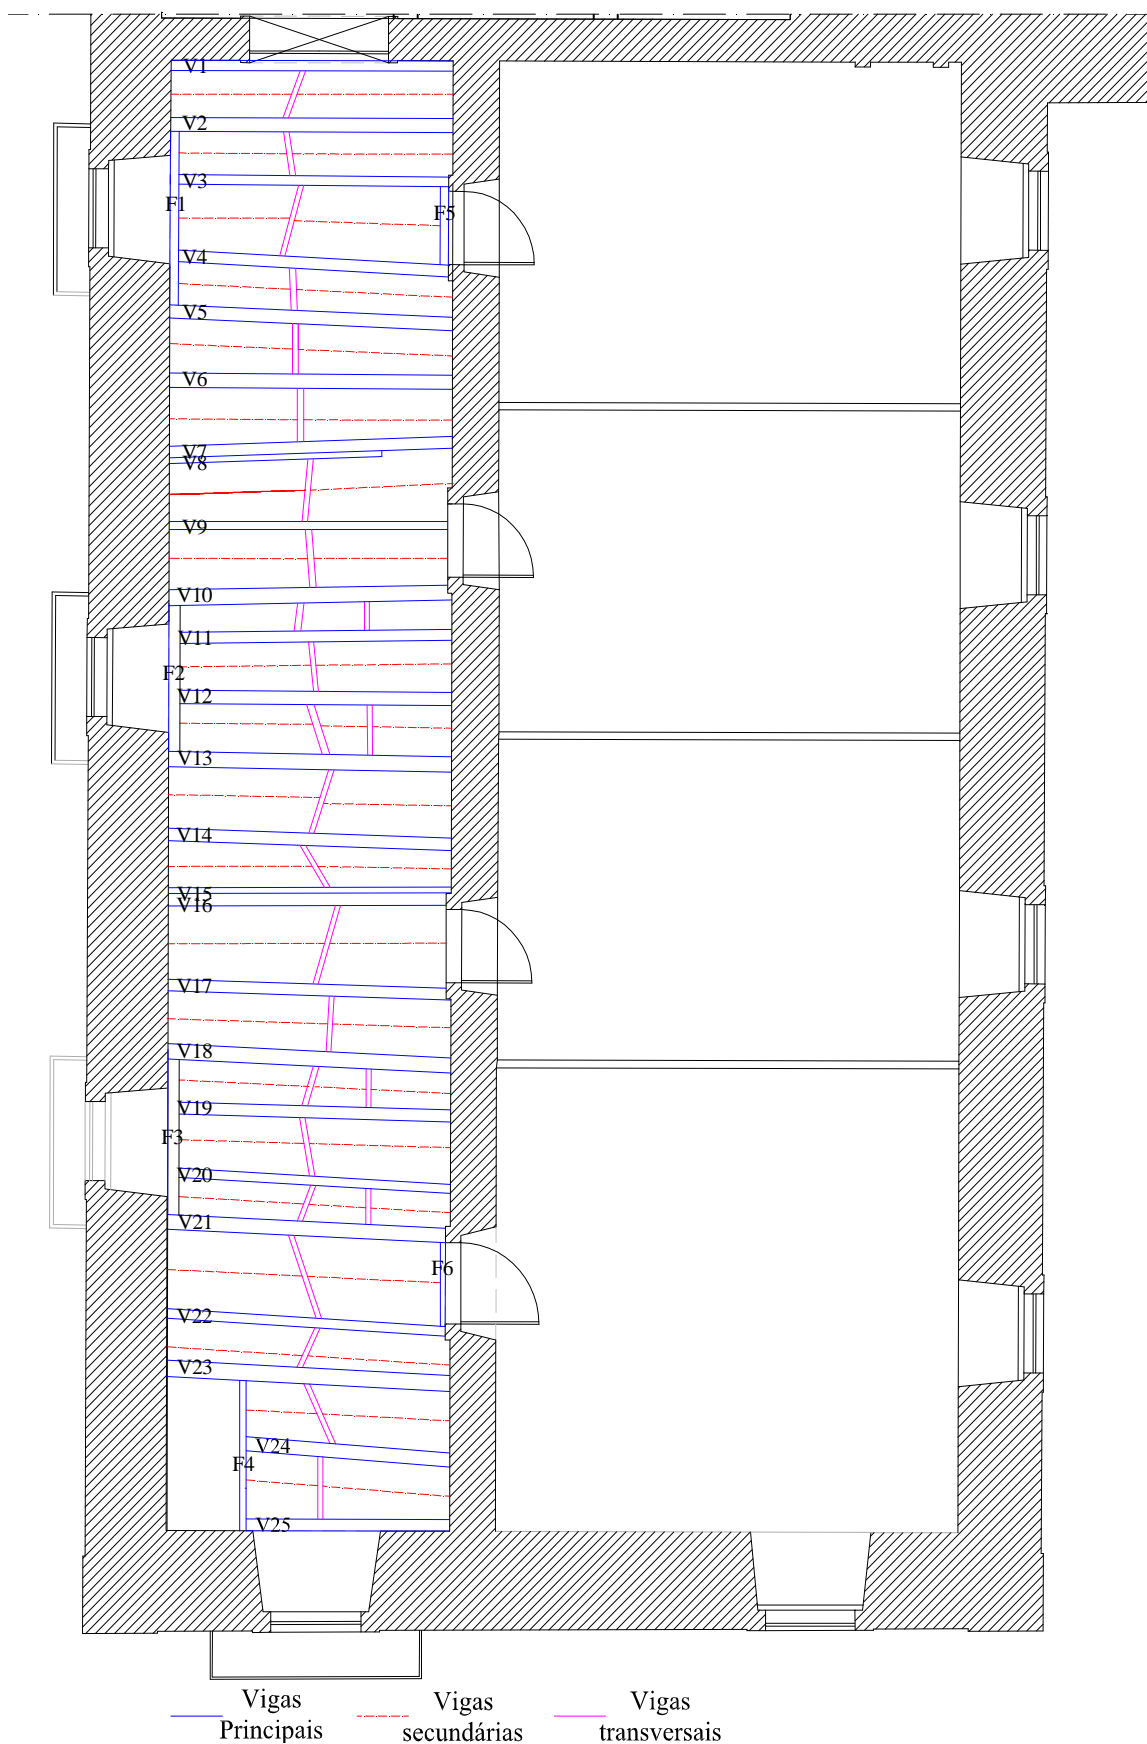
Planta estrutural do pavimento da área de estudo.
